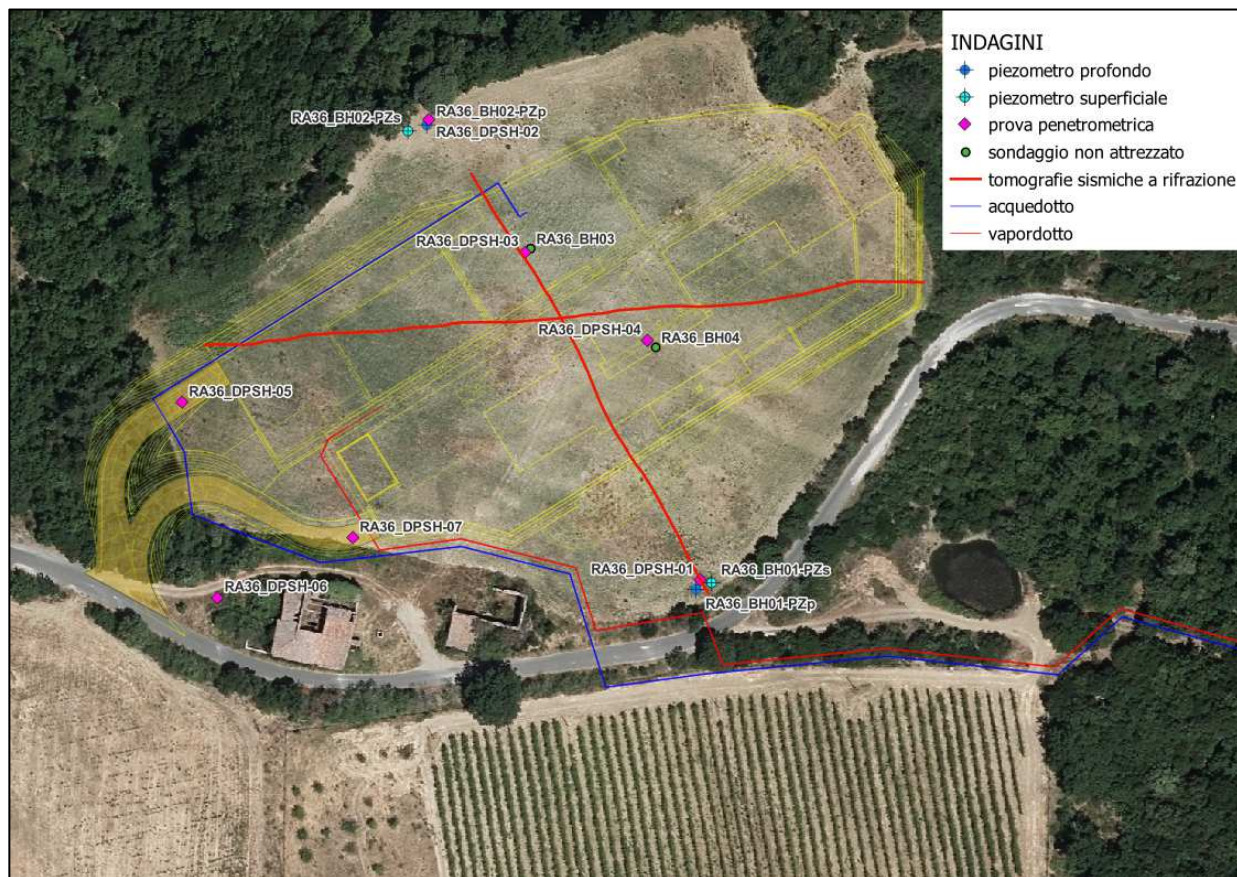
Vista aerea del sito con ubicazione della piazzola e delle indagini.
